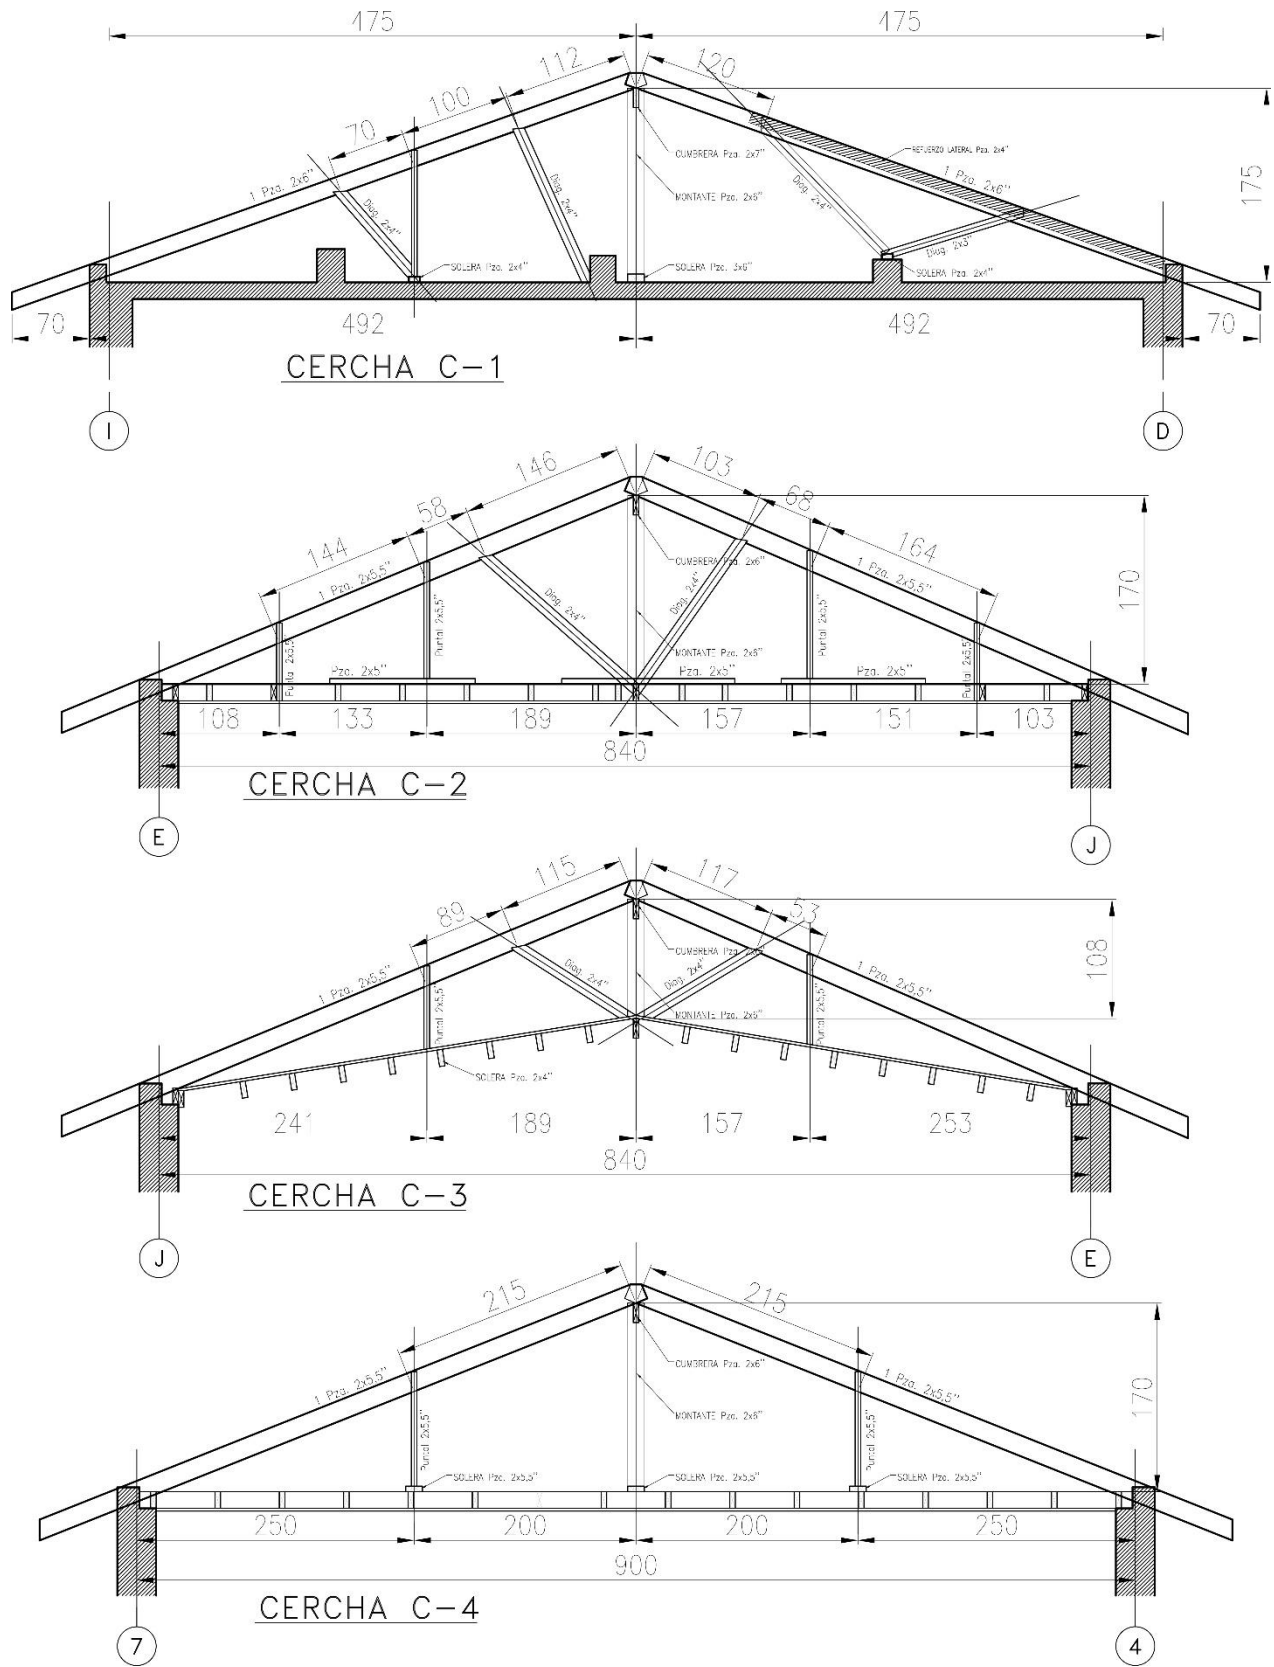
3 Detallamiento estructura de techo realizado por Consultora OM&S.
